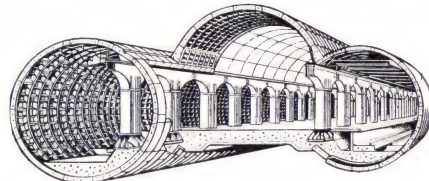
Станция метрополитена пилонного типа с обделкой из железобетонных тубингов.
